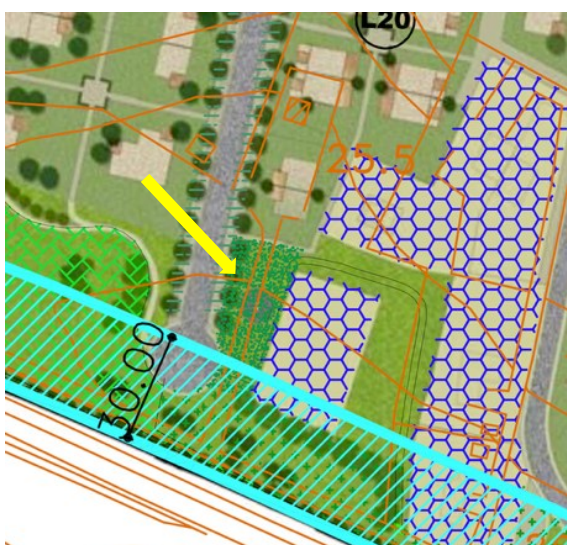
stralcio della tavola B12bis. Piano di Lottizzazione sovrapposto alla Carta Tecnica. Si rileva che il trullo è traslato rispetto alla posizione reale in quanto si sovrappone alla strada di accesso esistente
